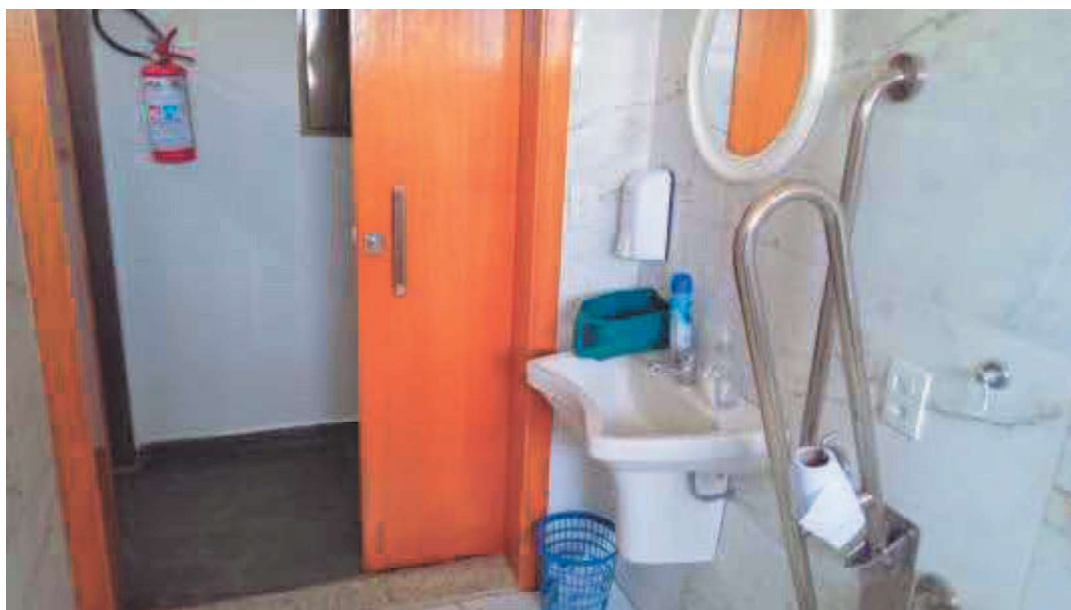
Porta do banheiro e lavatório (lavatório não possui barras de apoio).
